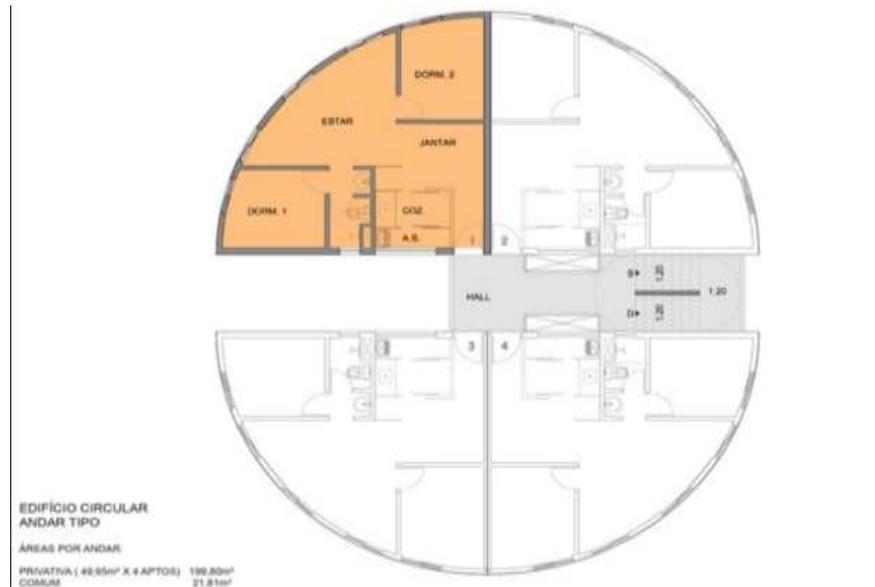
Planta pavimento tipo 4 unid. p/ pavimento
